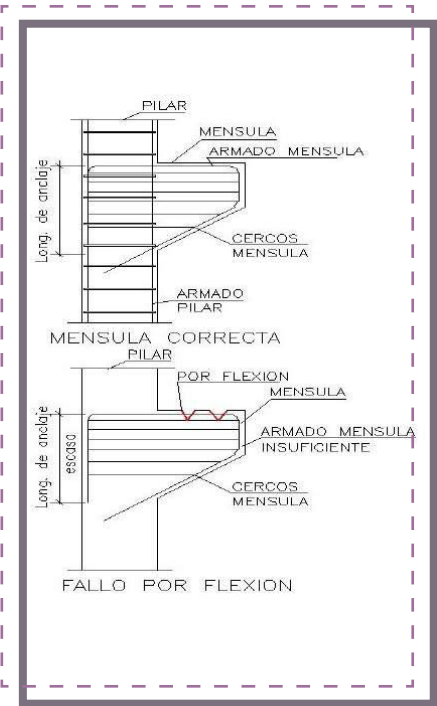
Esquema de las fisuras en ménsula de hormigón armado por rotura a flexión.
